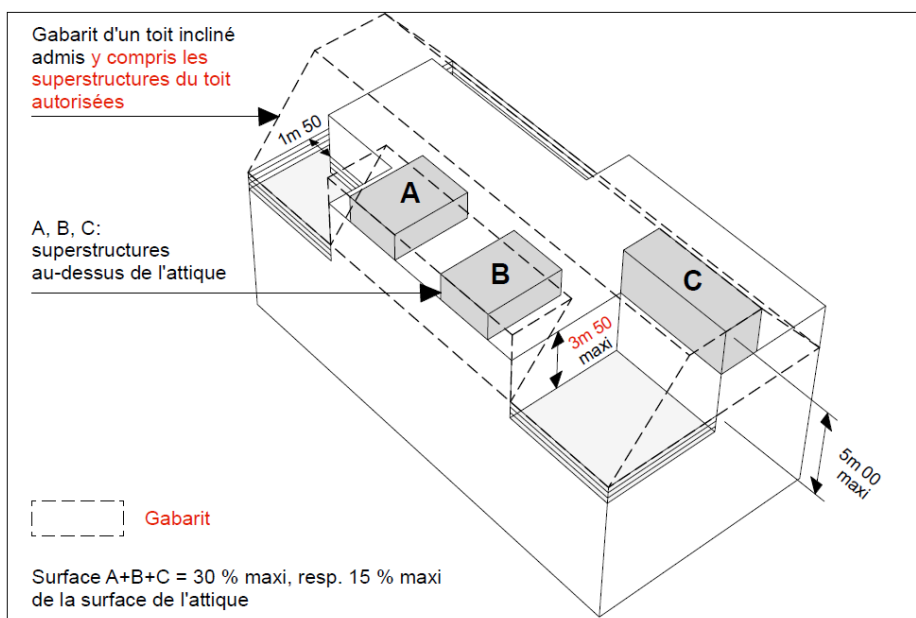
gabarit des attiques et superstructures sur attique (rouge : modification du croquis existant)
